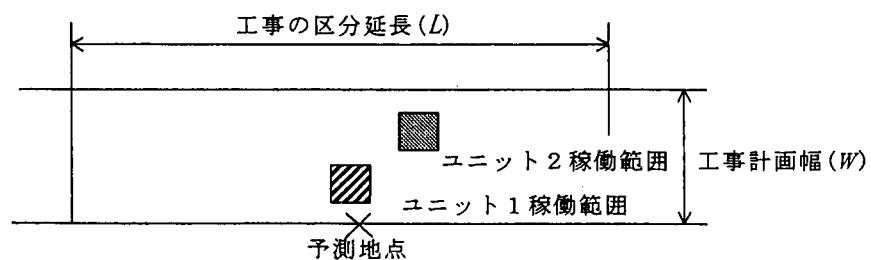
施工範囲が特定されない場合の施工範囲の配置例
